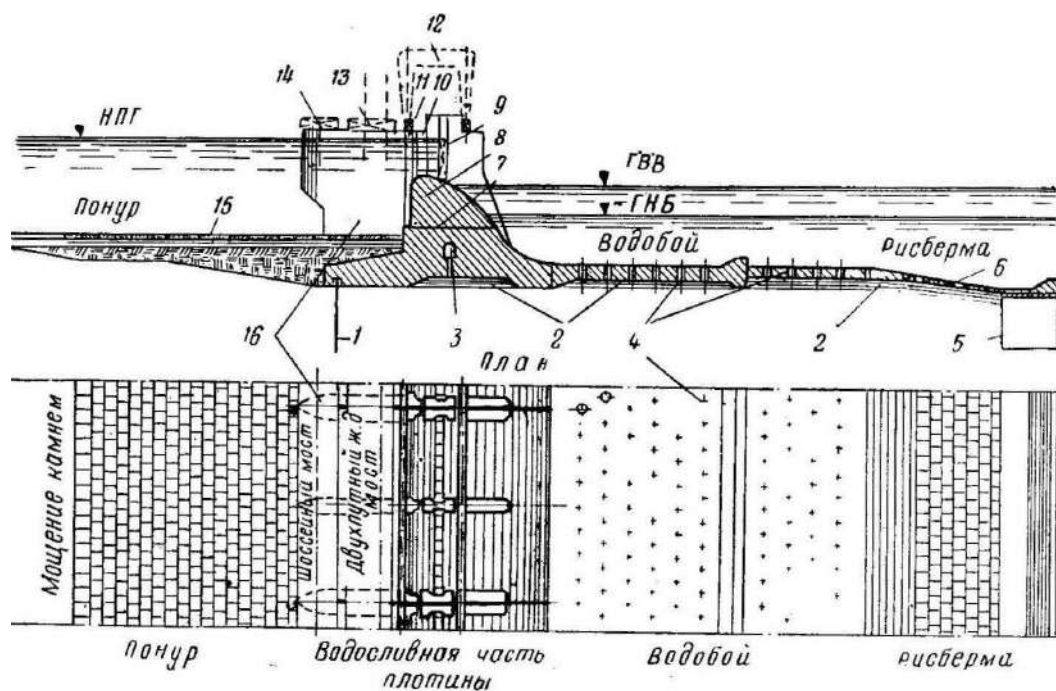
Конструкция бетонной плотины на песчаном основании: 1 — металлический шпунт; 2 — обратный фильтр; 3 — дренажная галерея; 4 — дренажные отверстия; 5 — ячеистая стенка (металлический шпунт); 6 — плиты; 7 — часть тела водослива, возводимая способом гребенки; 8 — водослив; 9 — рабочий эксплуатационный затвор; 10 паз для балок ремонтных заграждений; 11 — паз для заграждений на период строительства; 12 — порталный кран; 13 — двухпутный железнодорожный мост; 14 — автомобильный мост; 15 — плиты; 16 — бык
